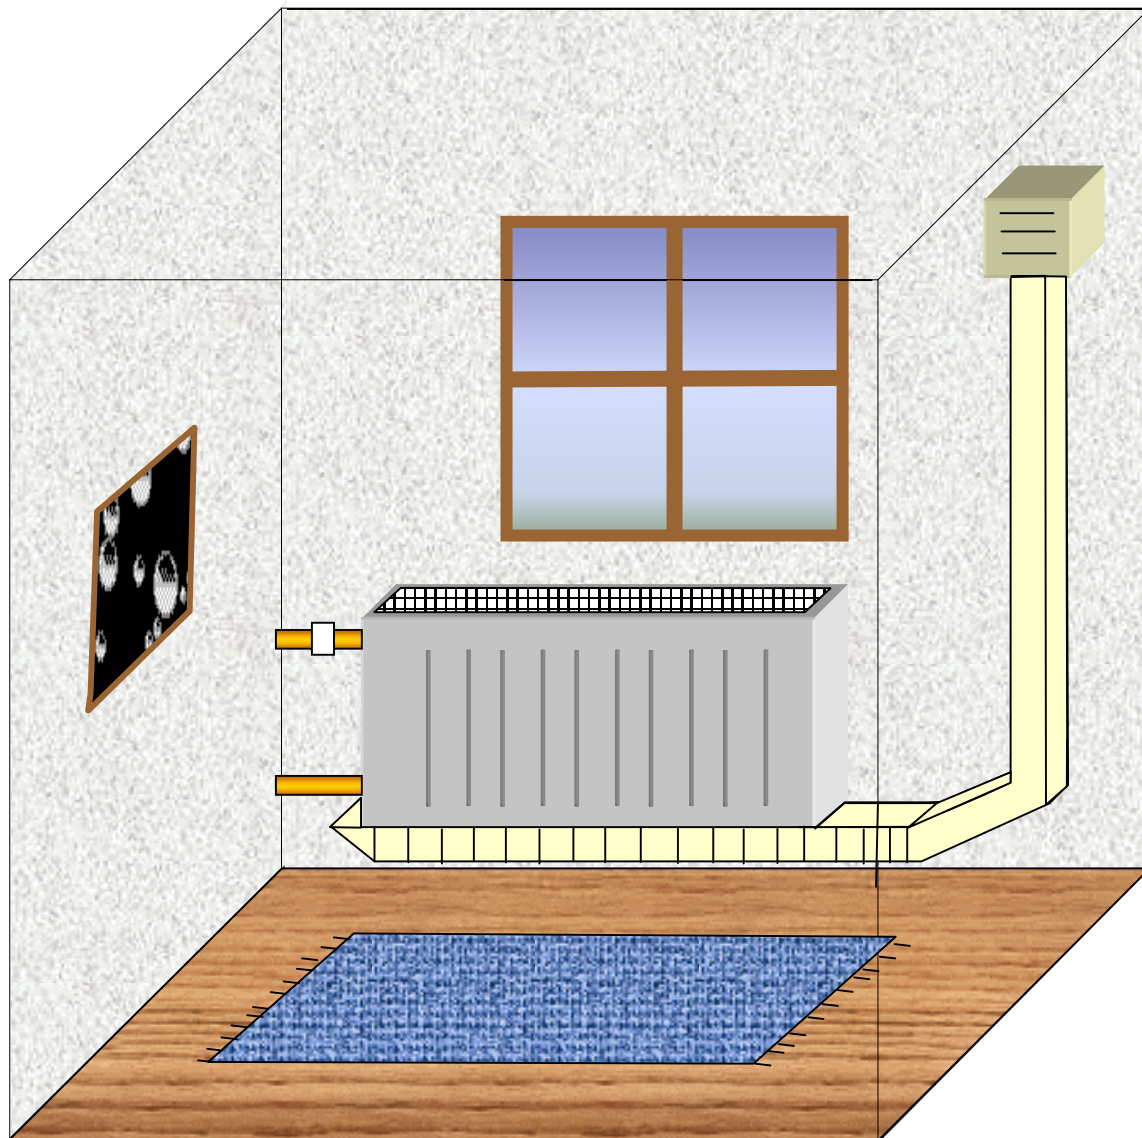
Ein Zimmer, welches nach der MMO-Methode gekühlt wird.
